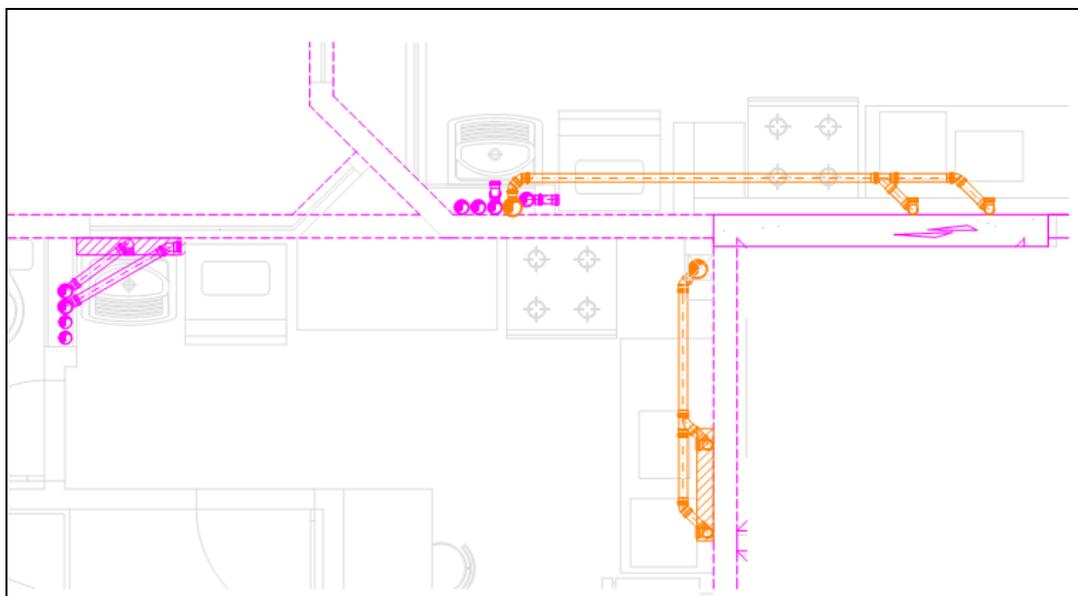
Representação dos ramais dos banheiros suíte e social das colunas 1 e 4 do pavimento tipo da obra
